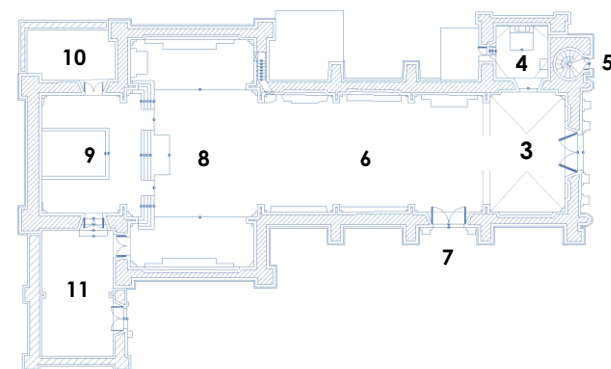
Planta Baja, Parroquia San Francisco de Asís, Chietla
